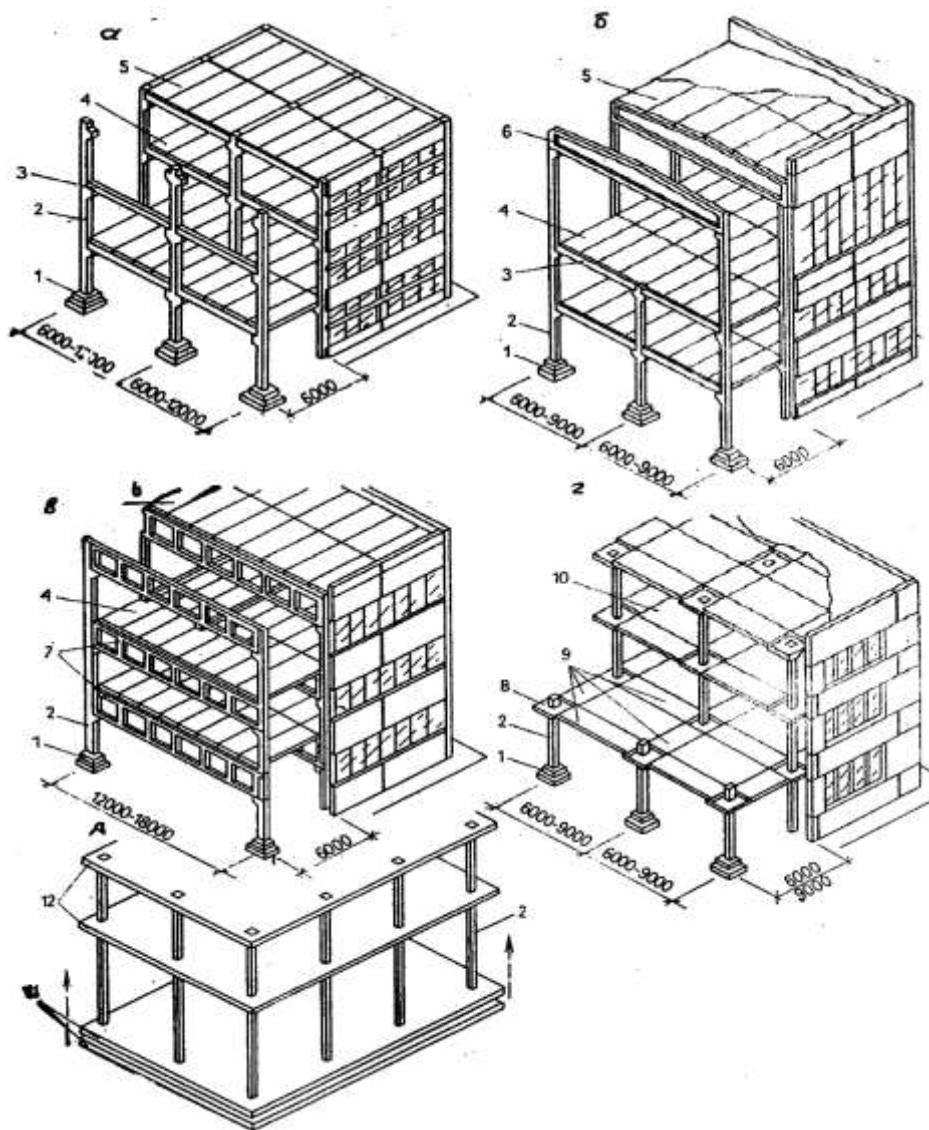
Залізобетонні каркаси багатоповерхових будівель: а — стійково-балковий; б — стійково-балковий із збільшеним верхнім прольотом; в — велико-пролітний; г — без балковий; д — з монолітним перекриттям; 1 — фундамент; 2 — колони; 3 — ригелі; 4 — плити перекриття; 5 — плити покриття; 6 — кроквяні балки; 7 — безкаркасні ферми; 8 — капітель; 9 — надколонні плити; 10 — пролітна панель; 11 — «пакет» перекриття; 12 — перекриття, поставлені в проектне положення
